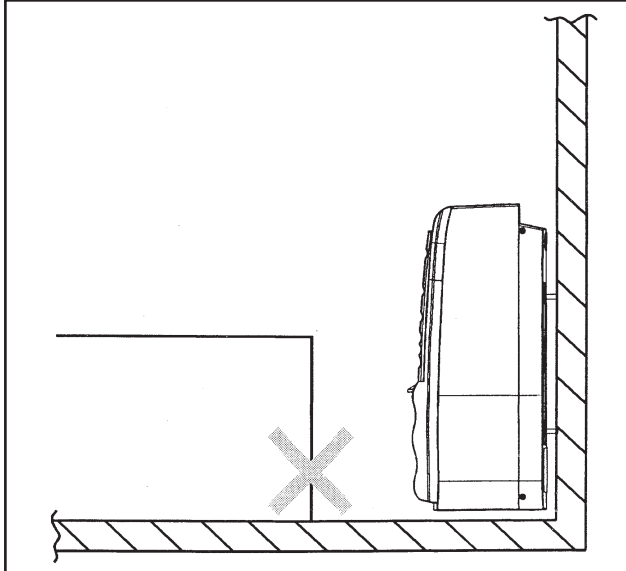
MONTAGEM DO PISO - CONSOLE
